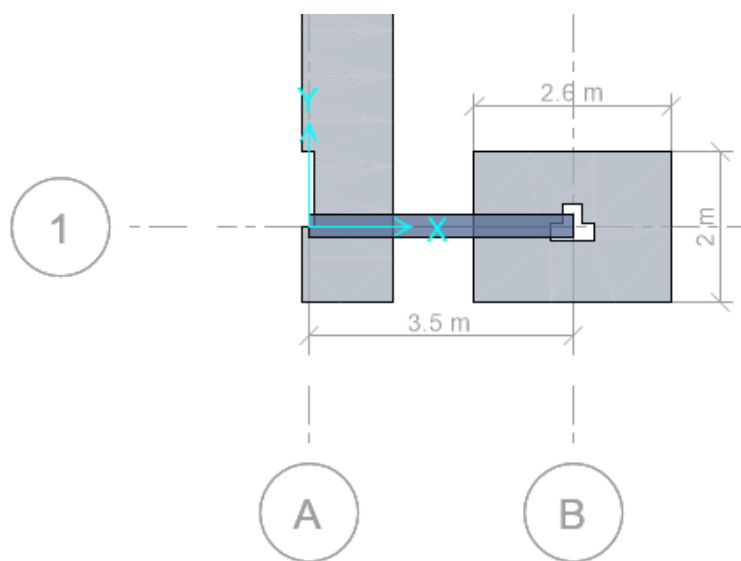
Modelo estructural cimentación conectada 1-B y viga de cimentación 1A-1B.
